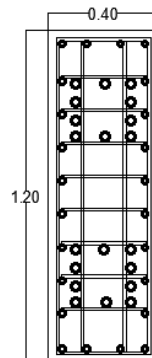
Detalle Acero Longitudinal y Transversal Viga de Acople C
